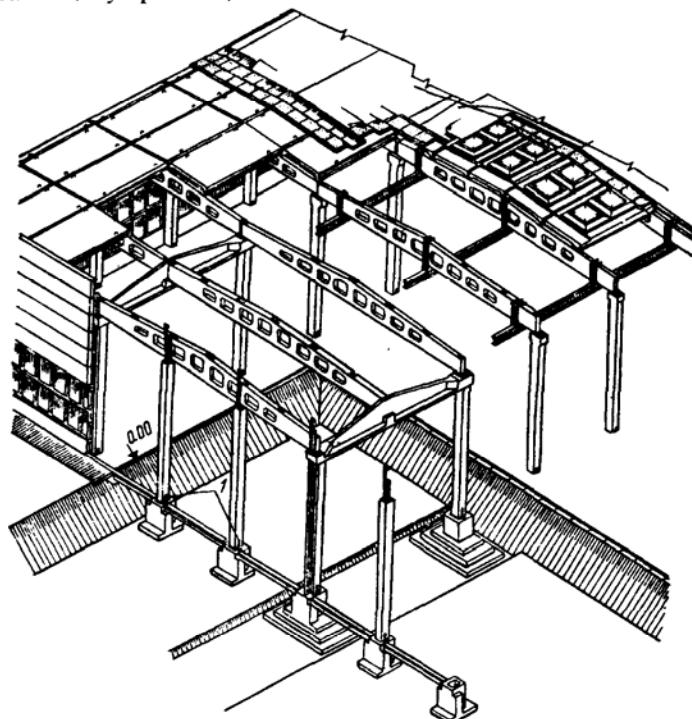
Монтаж перемычек заземления при использовании стропильных и подстропильных балок для соединения металлической арматуры здания:
